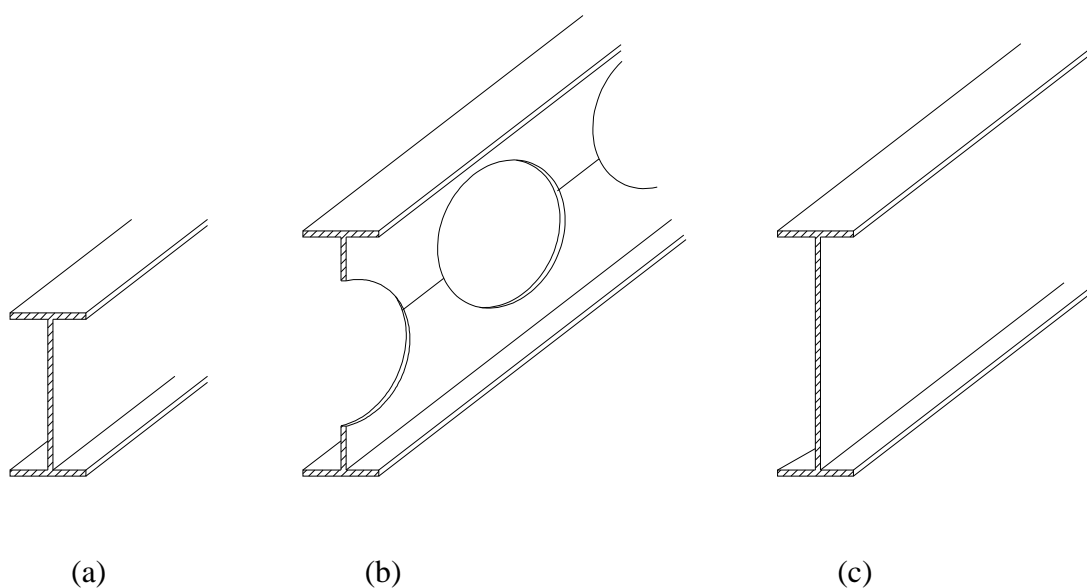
Tipos de vigas comparados neste estudo
